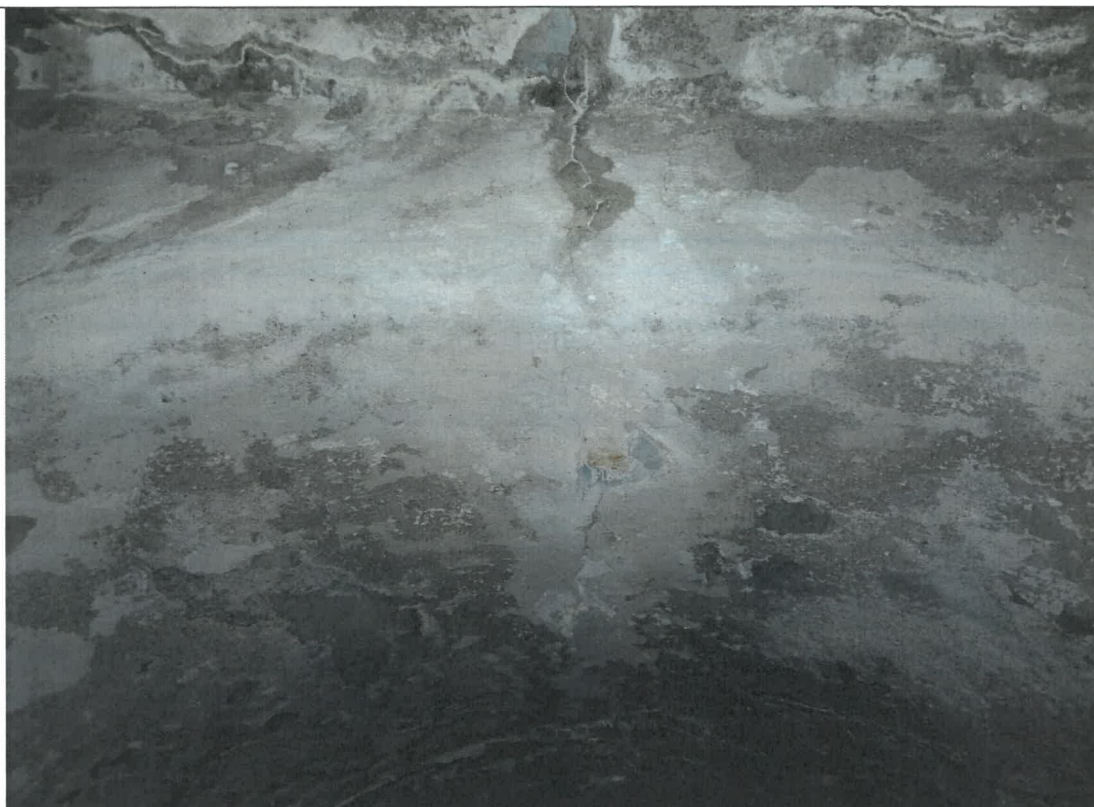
Crapaturi pronuntate ale betonului la intradosul boltii din beton.
